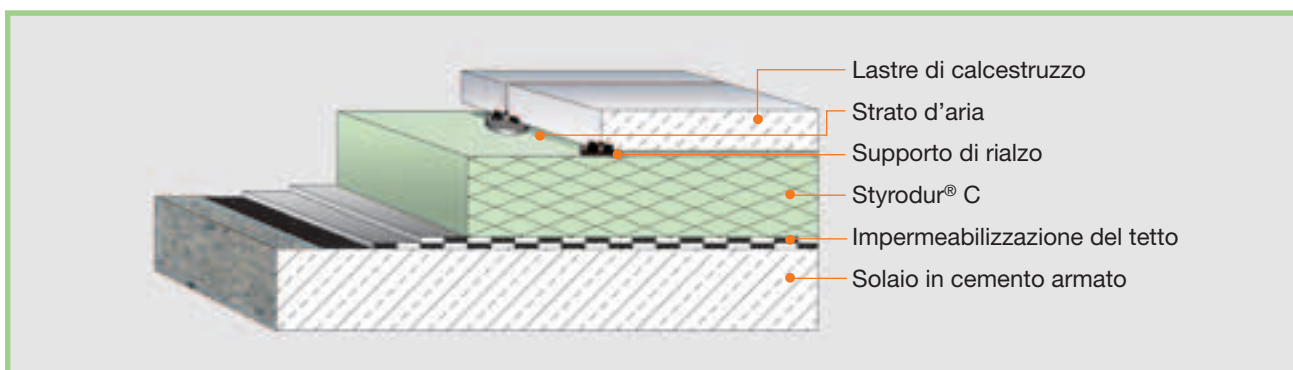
Tetto a parcheggio con lastre di calcestruzzo di piccolo formato, rialzate.
